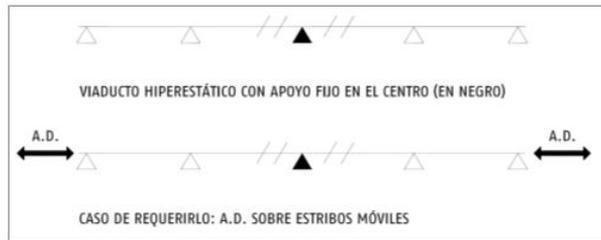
Disposición de aparatos de dilatación en estructuras hiperestáticas con apoyo central fijo
